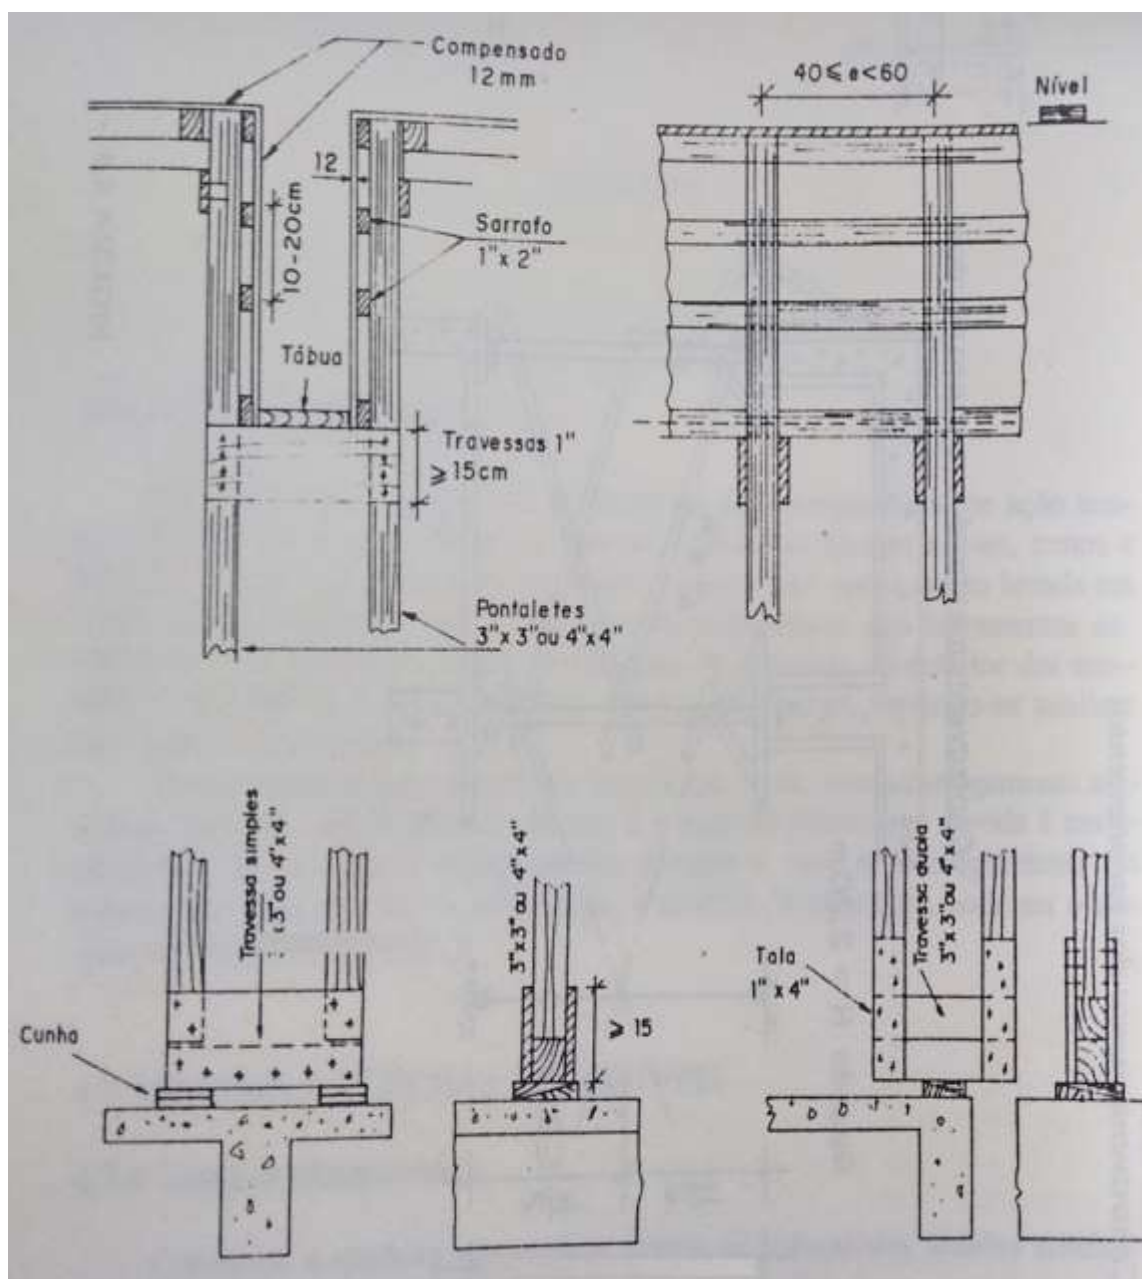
Detalhamento de fôrmas de madeira serrada para vigas com um dois panos de laje maciça.
